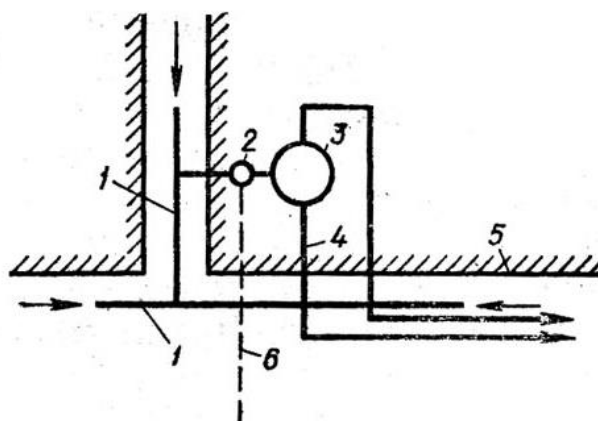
Схема расположения насосной станции и трубопроводов:
